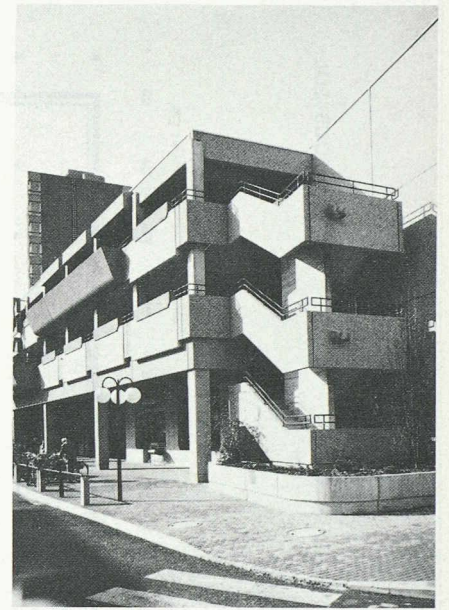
Détail de la façade sur la rue de Neuchâtel.
